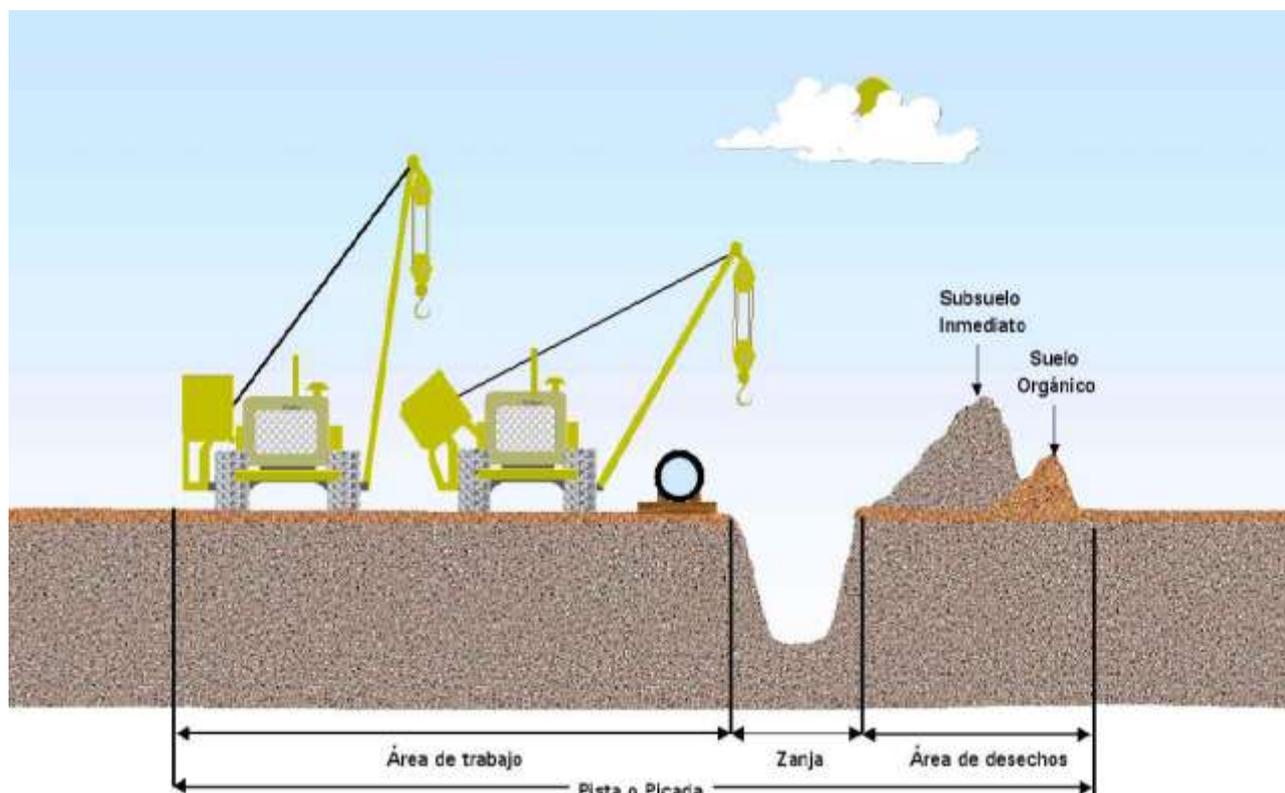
Esquema de apertura de zanjas. Corte transversal del terreno.
